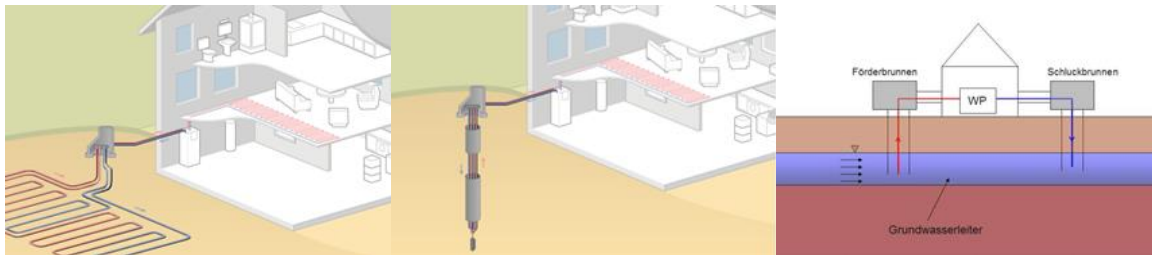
Erdwärmekollektoranlage, Erdwärmesonde und Erdwärmenutzung mittels Grundwasser
